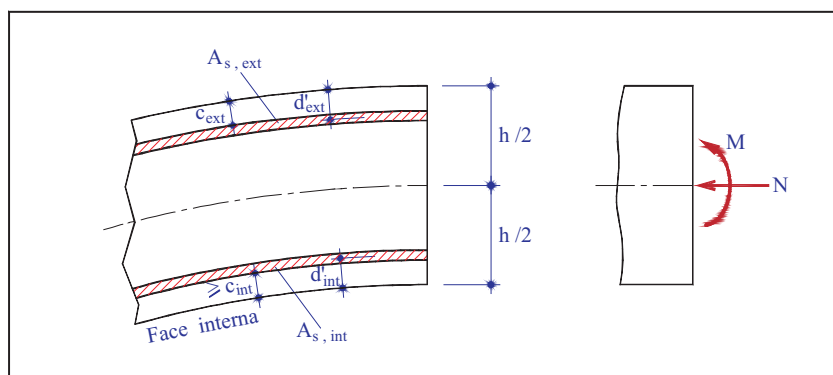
Posição da armadura na parede do tubo com arranjo de armadura circular simples
